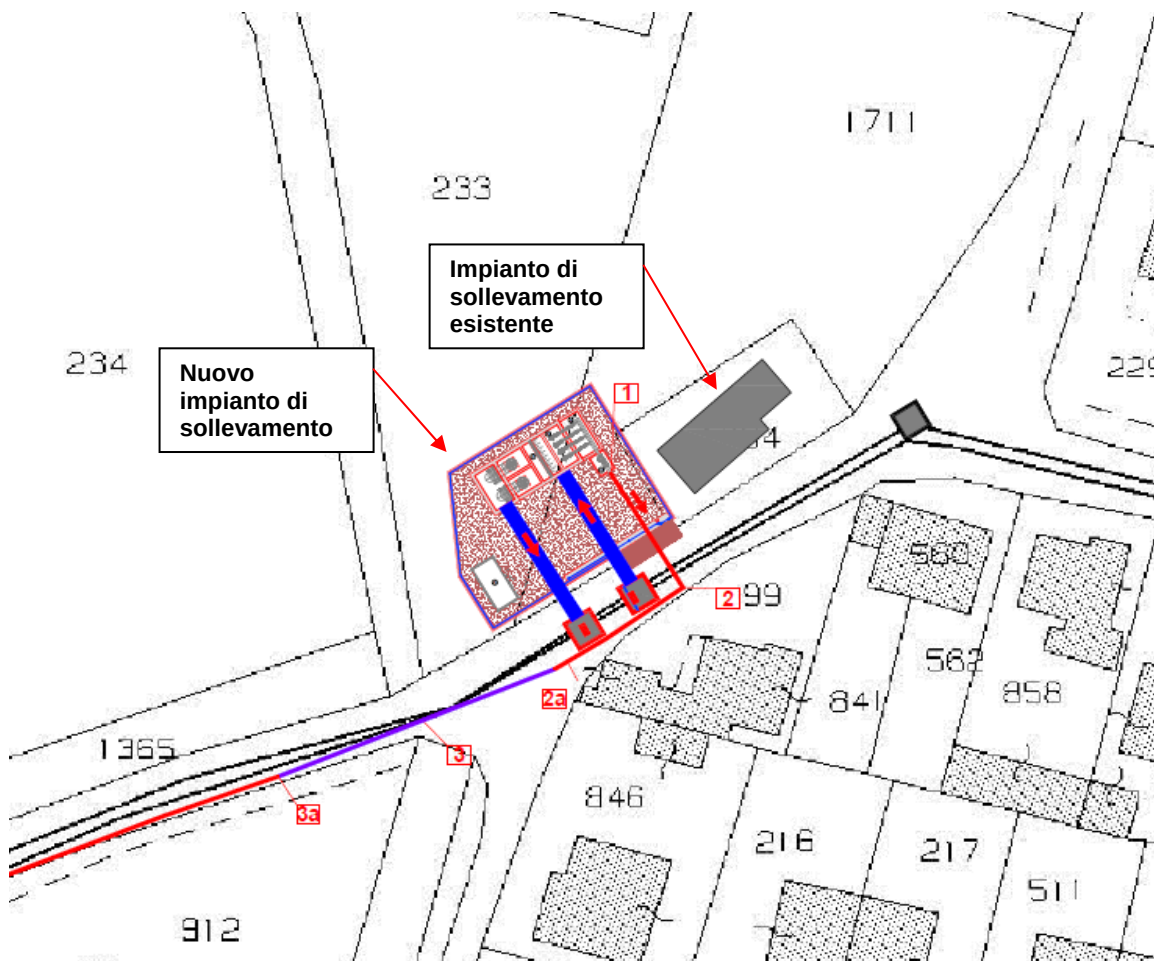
Estratto palnimetria su base catastale con opere di progetto
